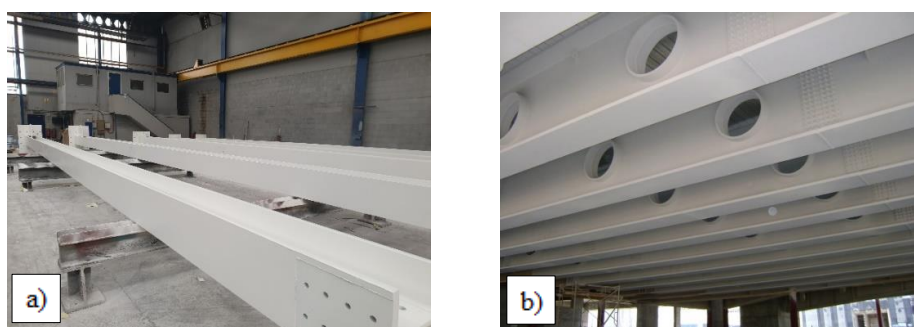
Tintas intumescentes: a) Aplicação do intumescente em perfis metálicos [61]; b) Proteção em vigas de piso [62].
